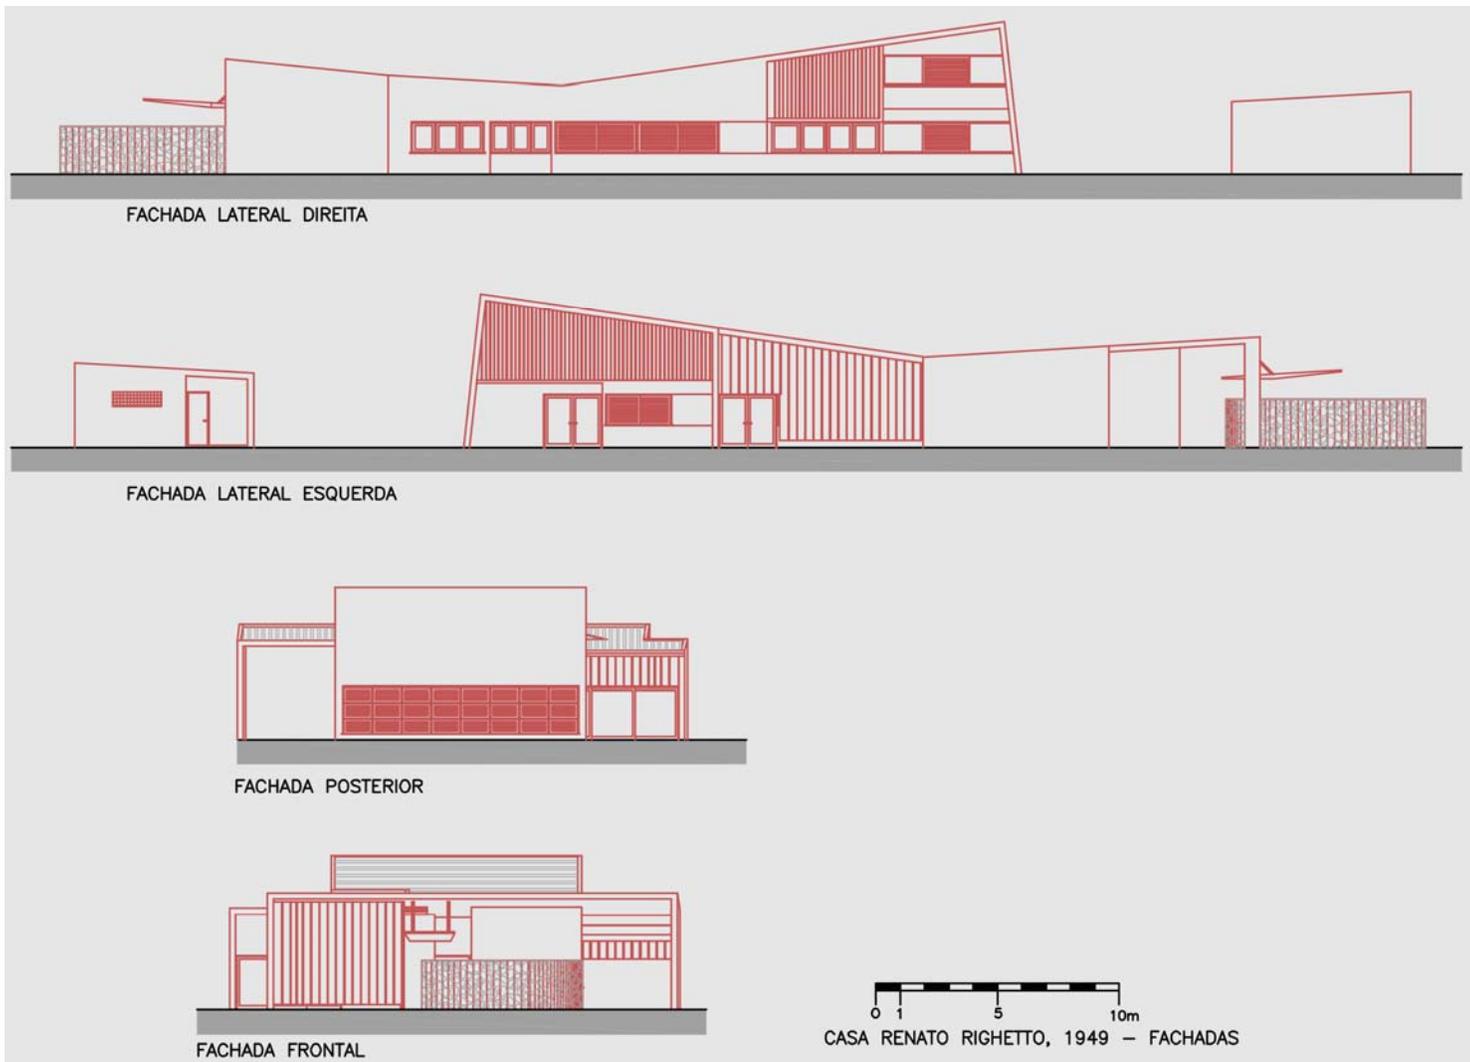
Casa Renato Righetto, 1949 – fachadas
